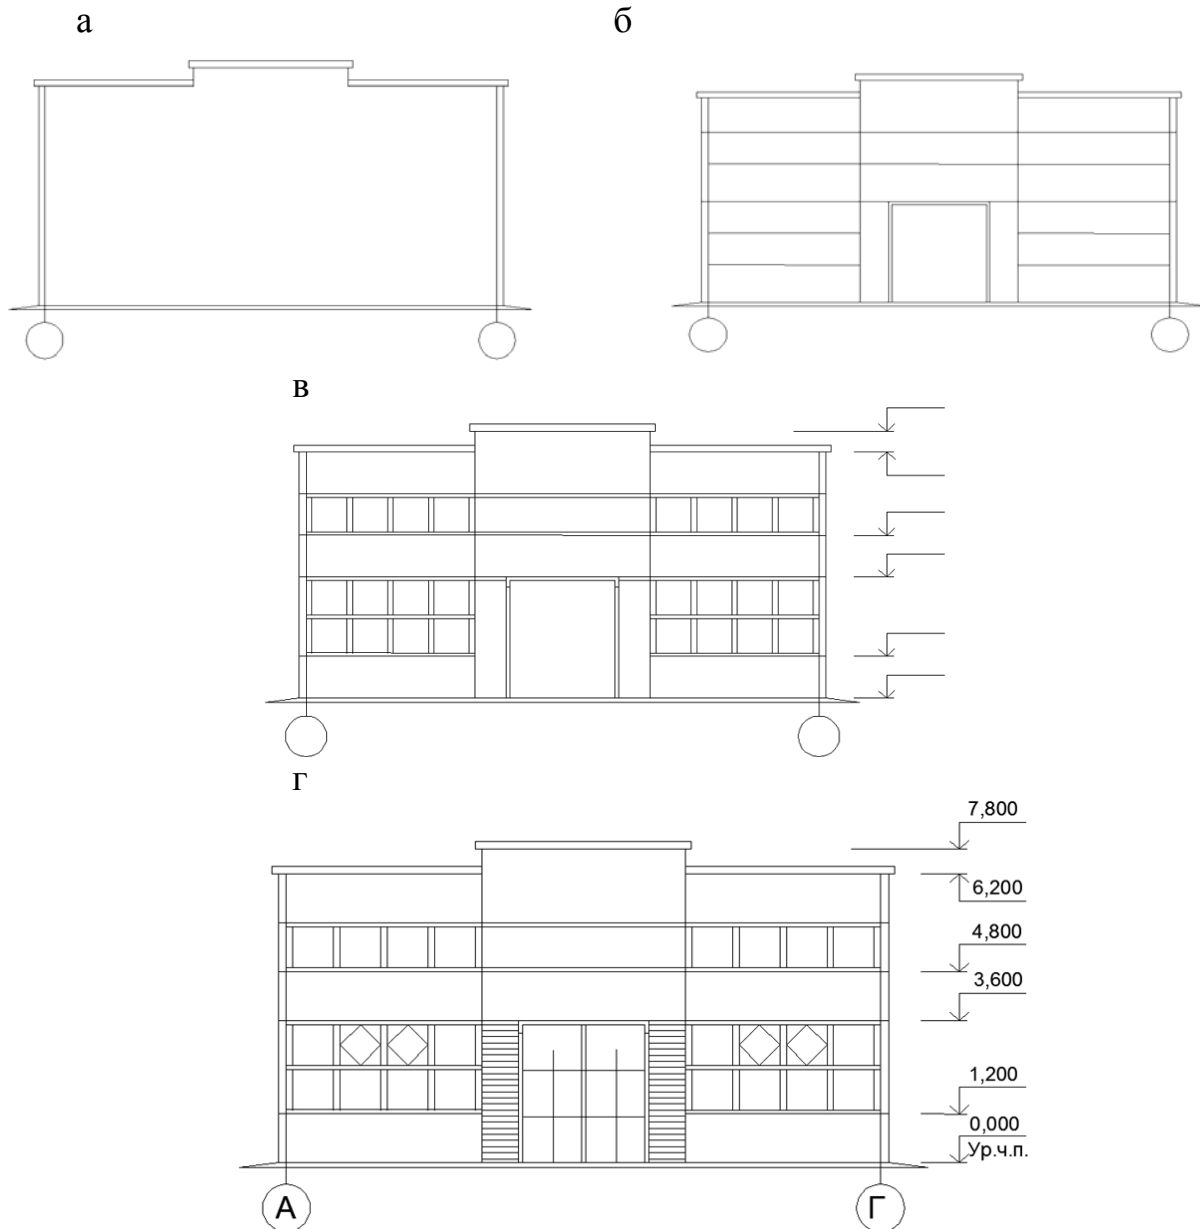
Последовательность (а...г) вычерчивания фасада здания
